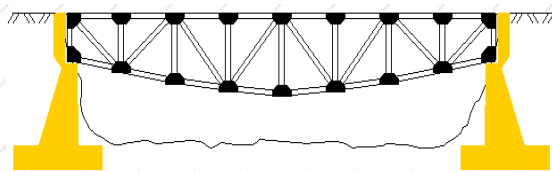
Puente con armadura metálica y arriostramiento inferior.
